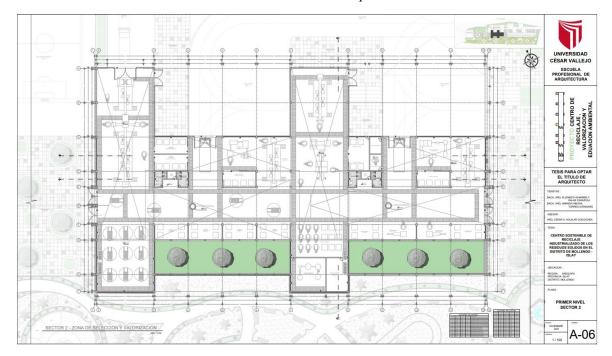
Planta de Distribución, Sector 2 – Primer Nivel FUENTE: Elaboración Propia
